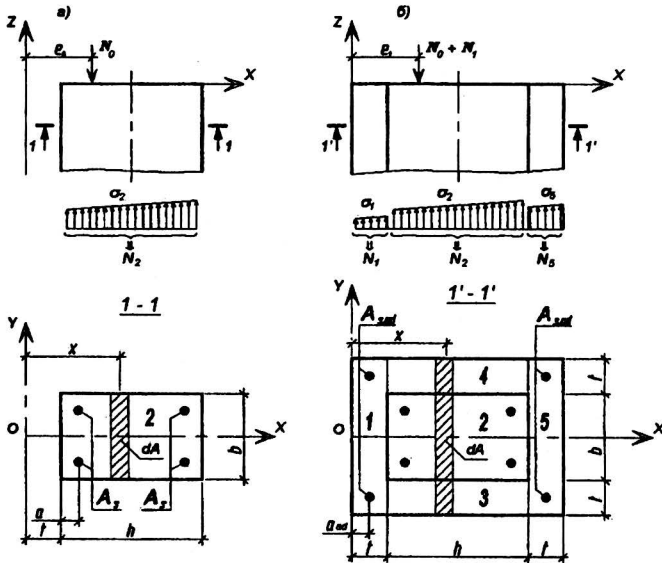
Расчётная схема элемента: а) – до усиления, б) – после усиления, A_s – площадь арматуры усиливаемого элемента, $A_{s,ad}$ – площадь арматуры обоймы
